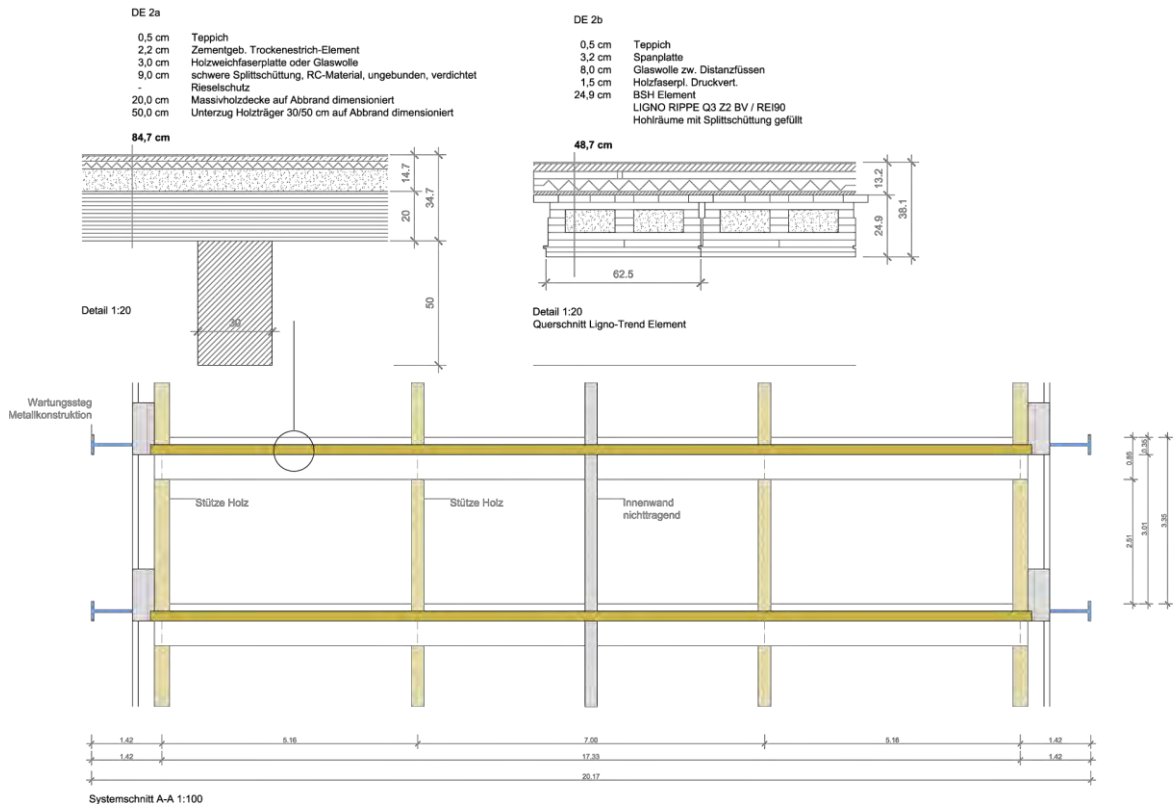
Tragstruktur aus Holz mit Holzunterzügen
